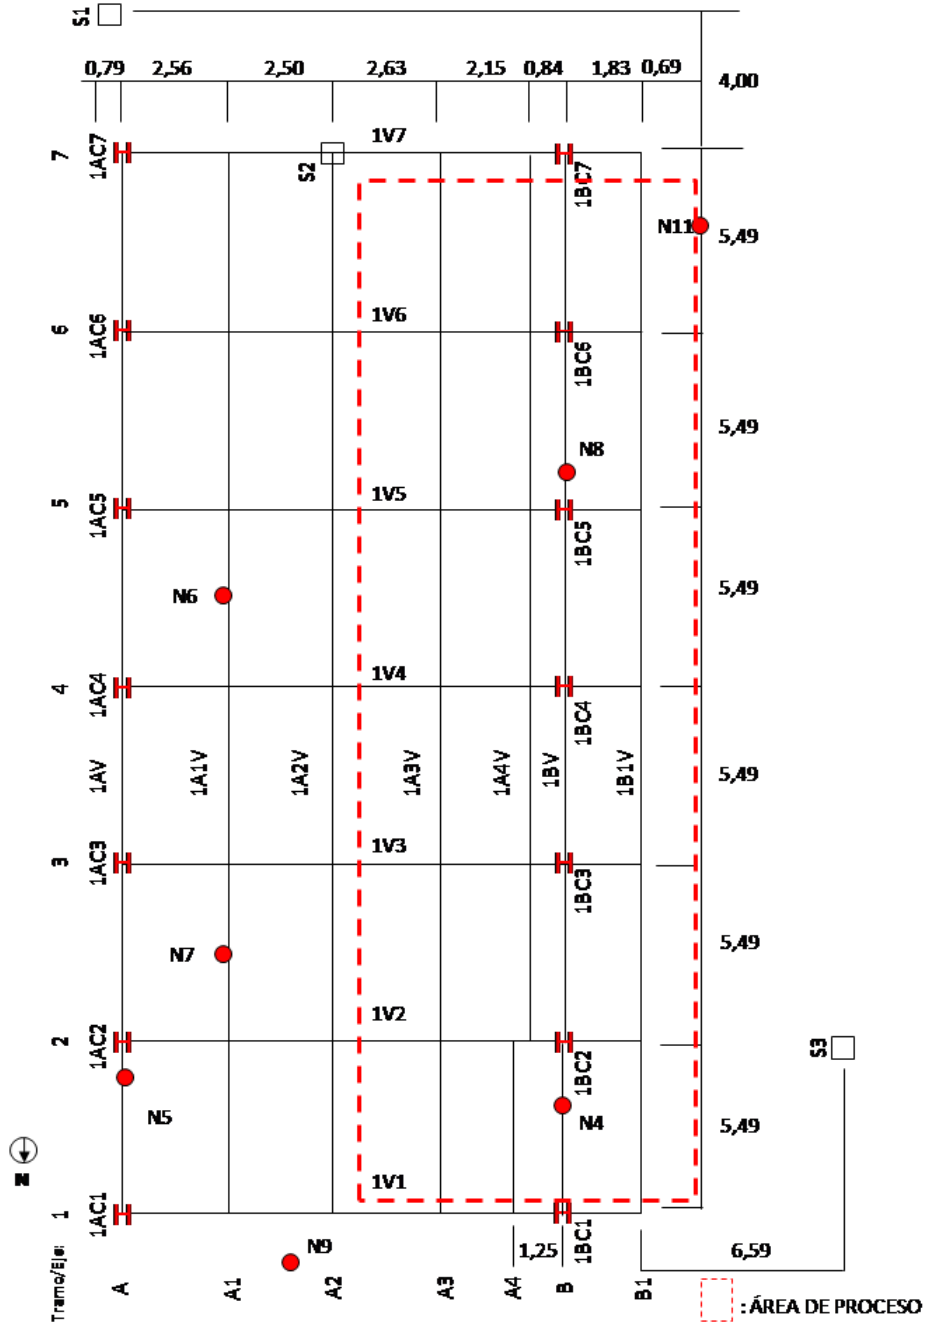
Planta del Nivel 1. Ubicación de Columnas, Vigas y Soportes, y sitios de extracción de testigos: N6, N7, N9 y N11, núcleos extraídos de la losa; N4, núcleo extraído en una viga del primer nivel; N5 y N8, núcleos extraídos en columnas.
